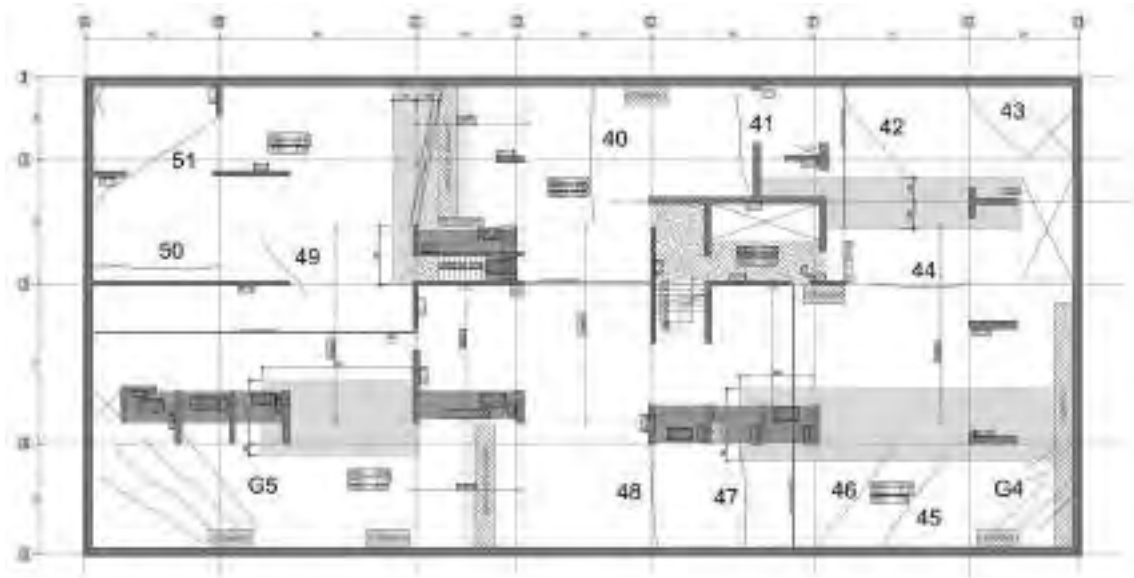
Ubicación de fisuras en sótano 5
